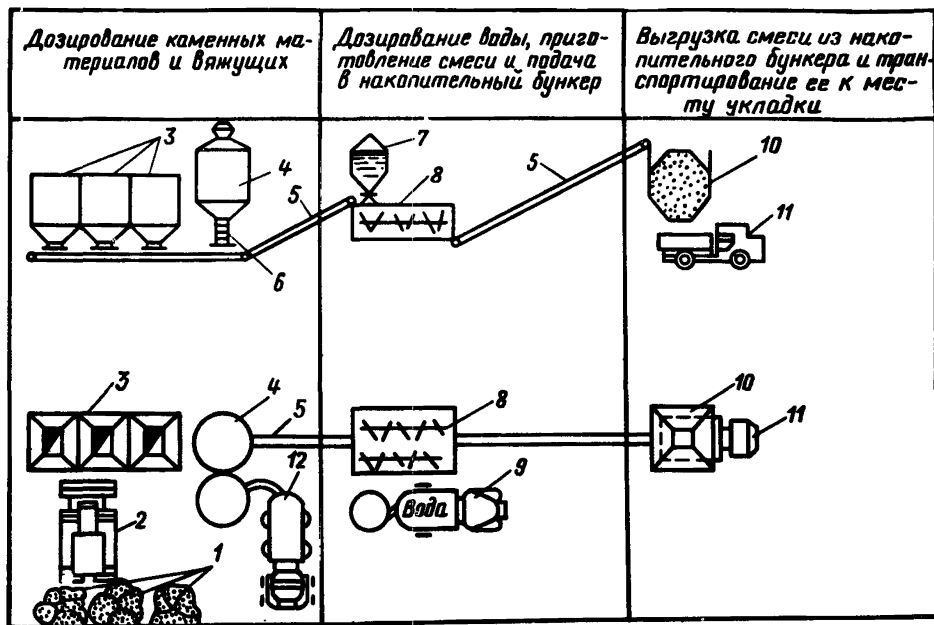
Примерная схема приготовления укрепленной смеси: 1- склад материалов; 2-автопогрузчик; 3-расходные бункера с дозаторами; 4-склад вяжущих; 5-транспортер; 6-дозатор вяжущих; 7-бак для воды; 8-смеситель; 9-поливно-моечная машина; 10- накопительный бункер; 11-самосвал; 12-цементовоз
